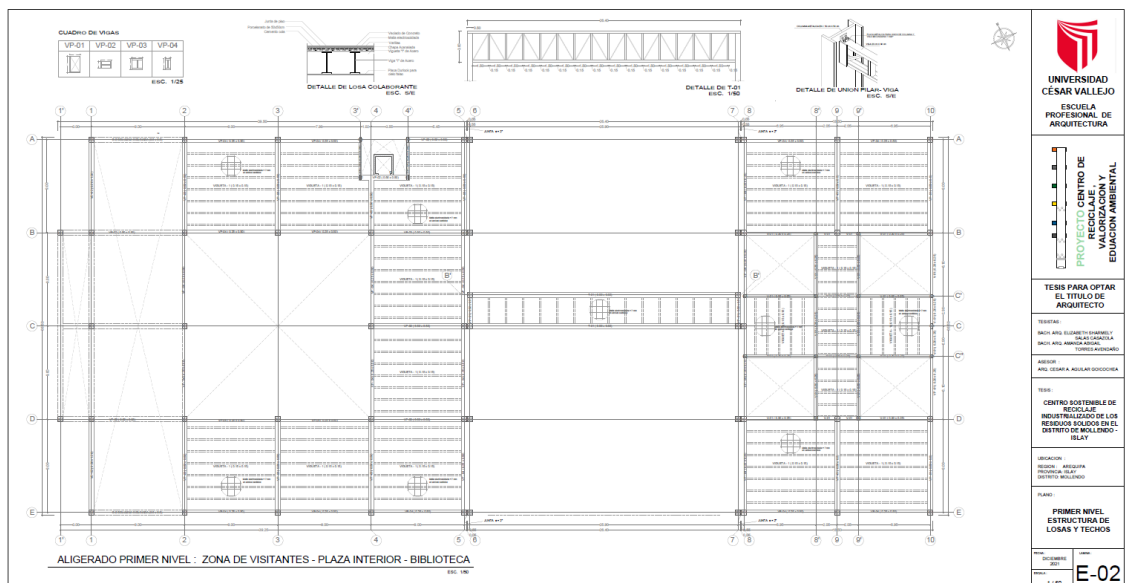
Plano de Aligerados, Sector Seleccionado - Primer Nivel
